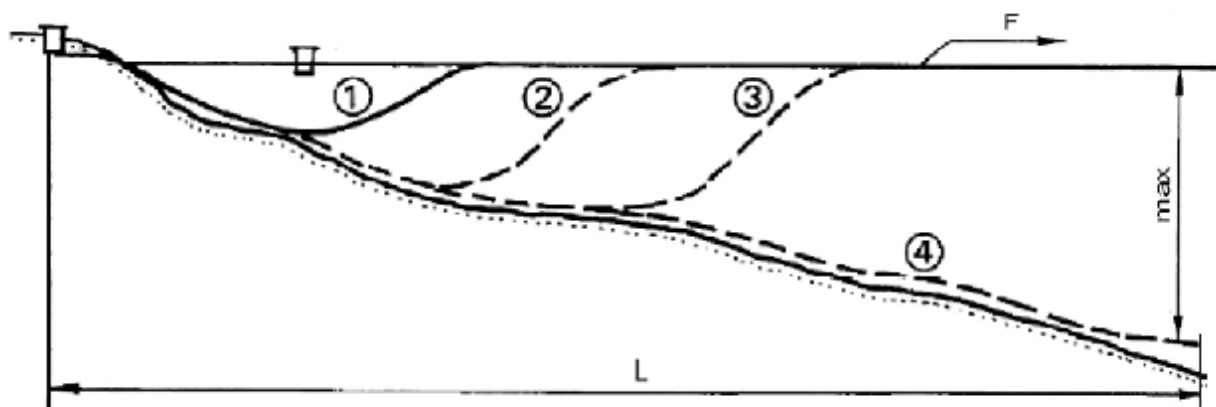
Установка водозаборного или водоотводящего трубопровода
